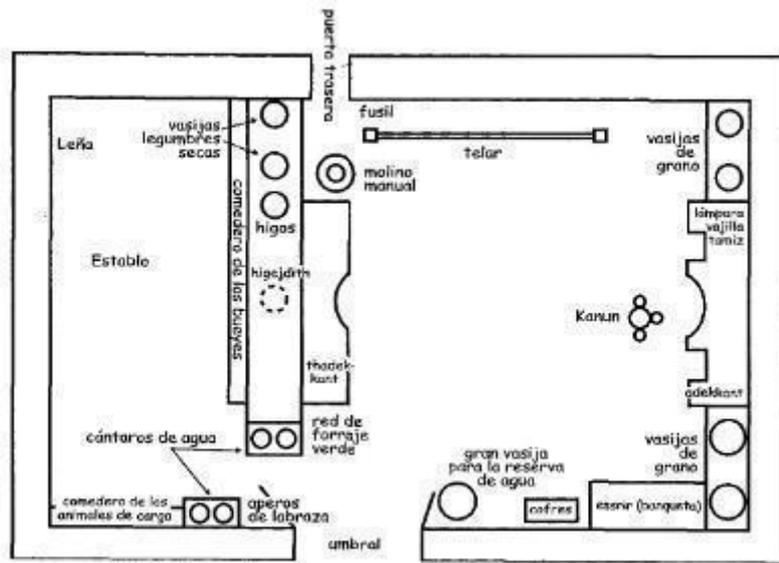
Planta típica de la vivienda bereber (Ibíd.).
